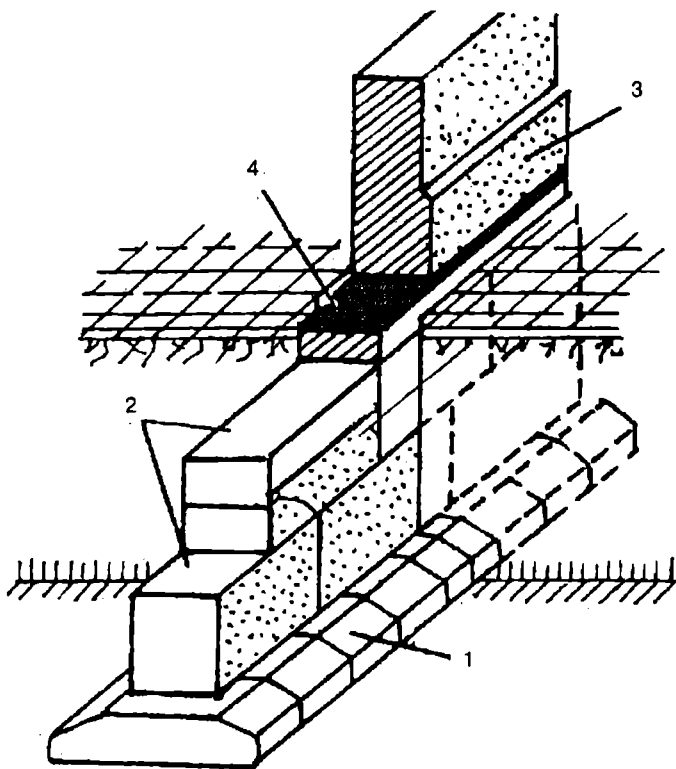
Фундамент из сборного железобетона с блоками-подушками:
